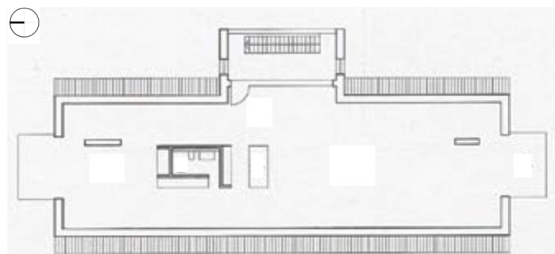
Pianta piano copertura; Fonte: www.720grad-architekten.ch
